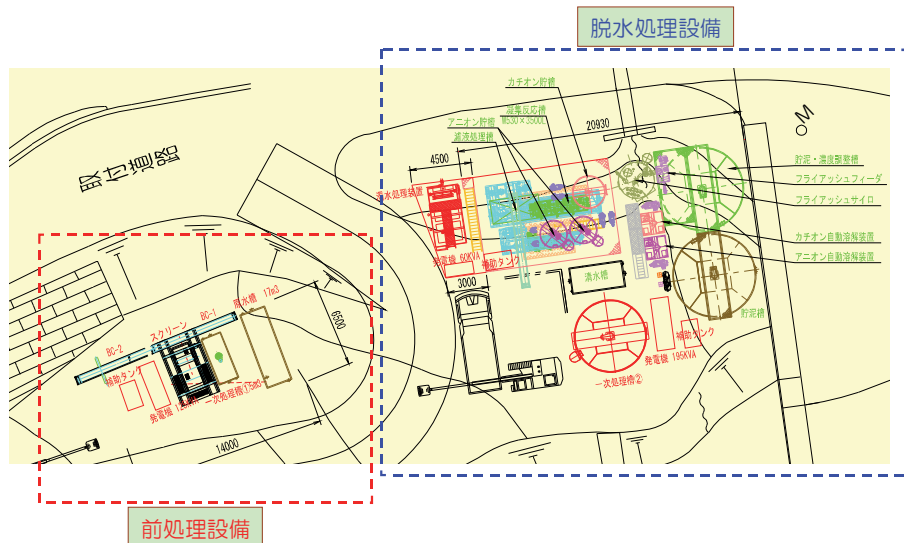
黒岳沢川第一号ダム除石工の脱水処理設備配置平面図
